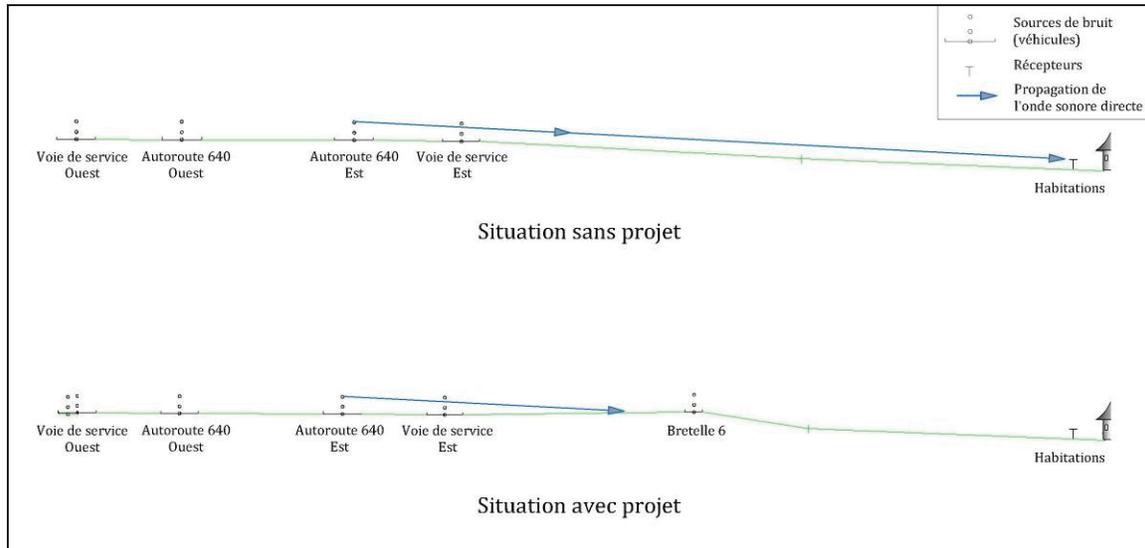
Coupe à la hauteur de la place Pierre-Côté
